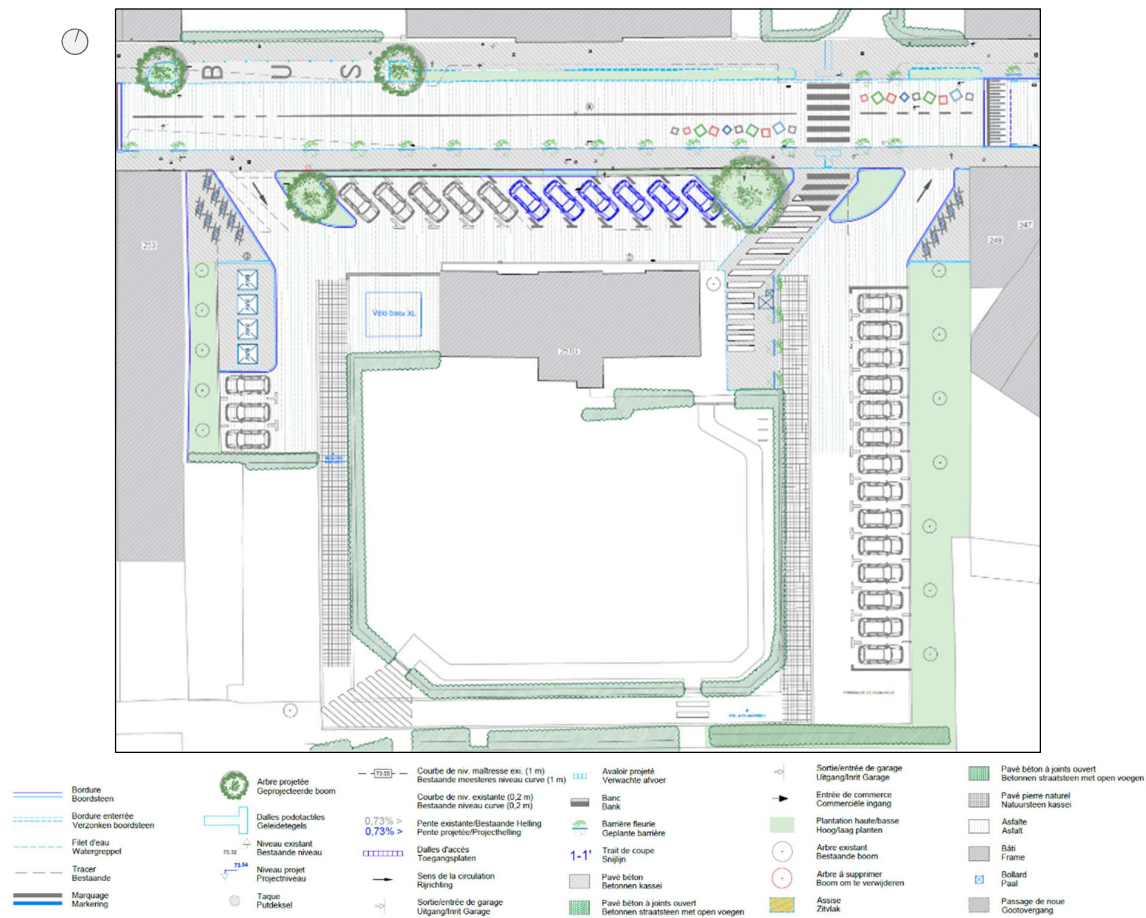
Voorgesteld plan voor het J.B. Degrooffplein (bron: aanvrager)
